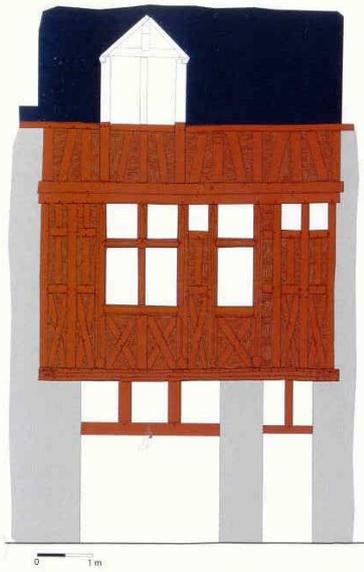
maison du 54 rue de la Charpenterie : élévation restituée de la façade lors de sa construction, vers 1540.
